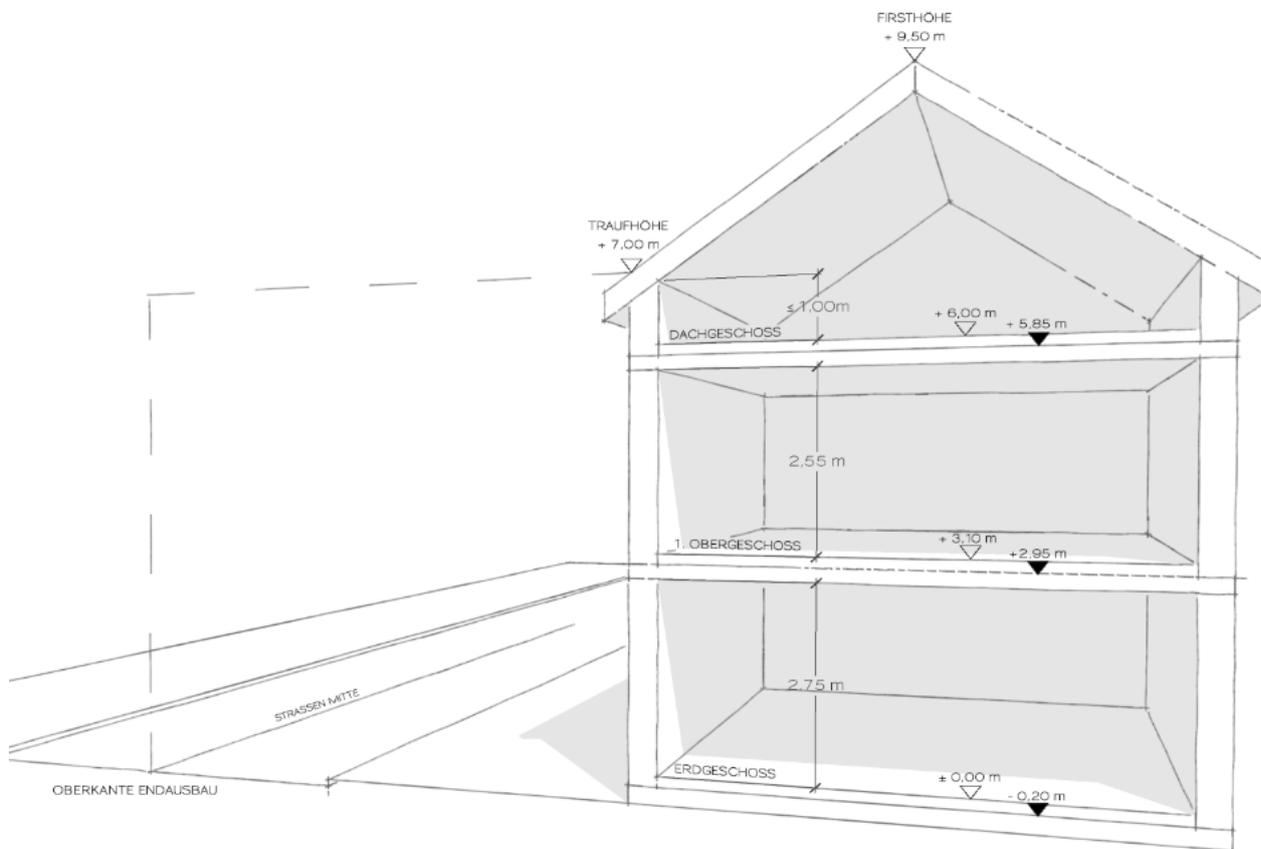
Systemskizzen zur Bemessung zulässiger Gebäudehöhen
